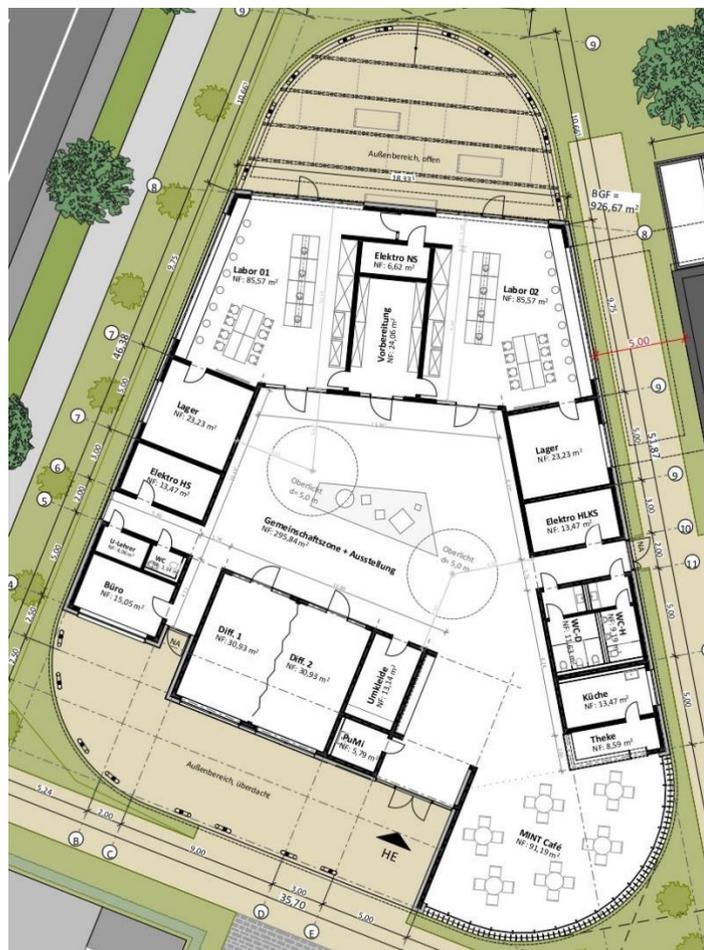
Grundriss MINT-Zentrum
